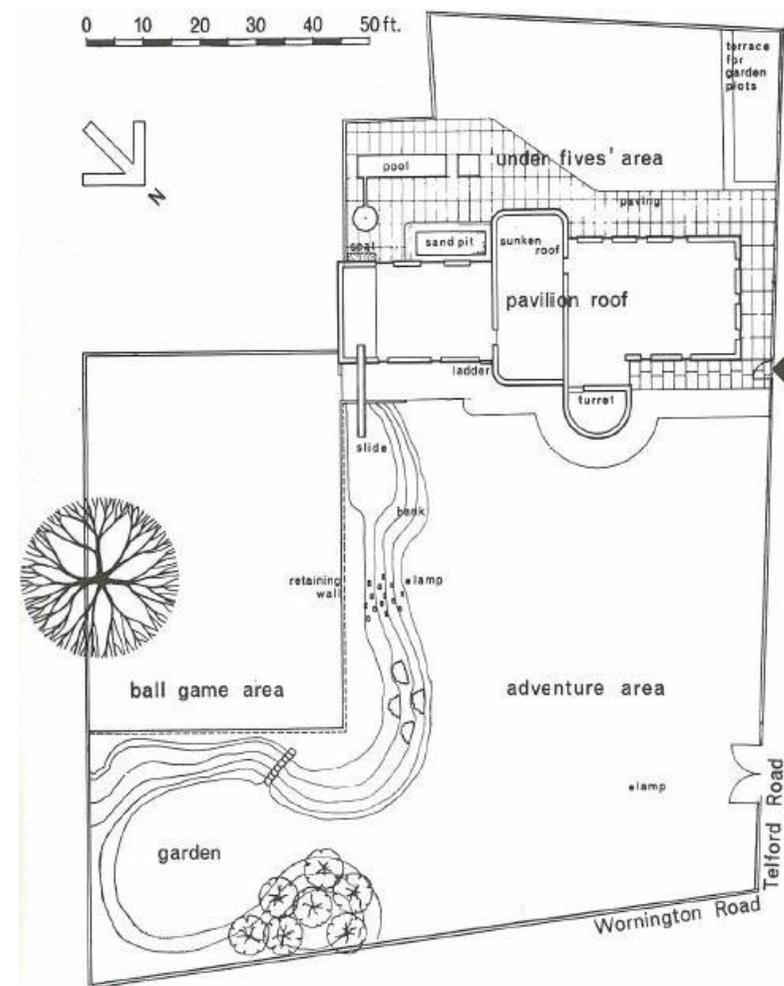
Planta general del Notting Hill *playground* en Londres (Inglaterra).
